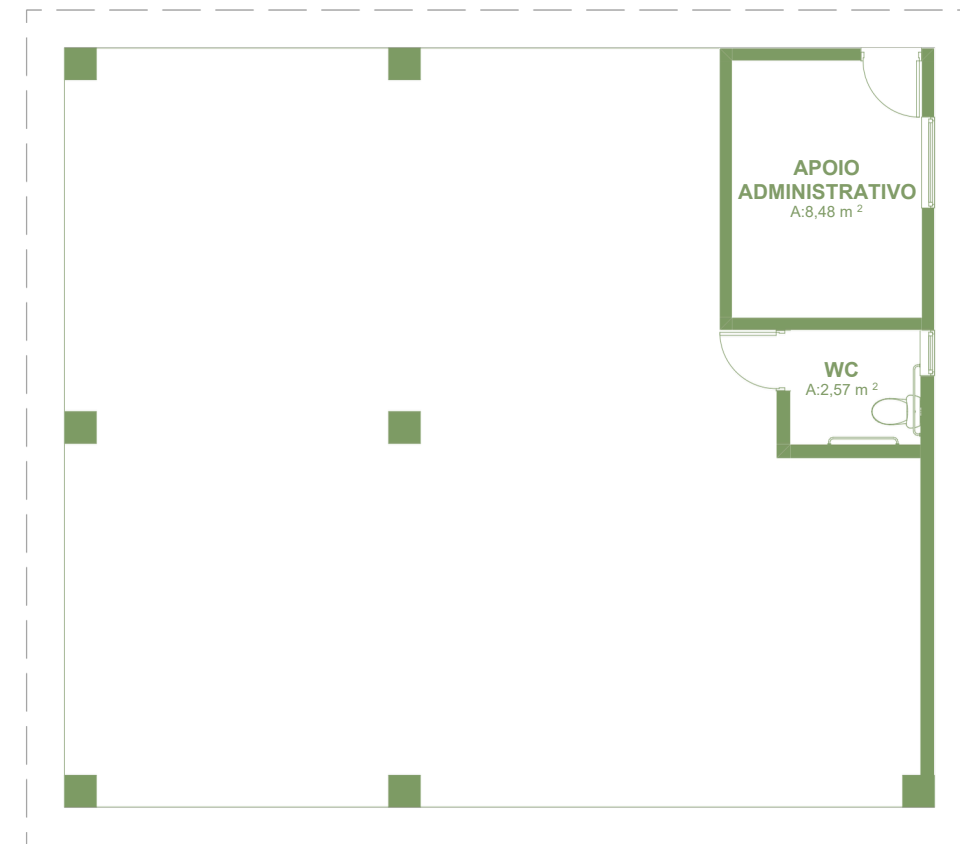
Planta original do projeto dos salões de festa do conjunto.
